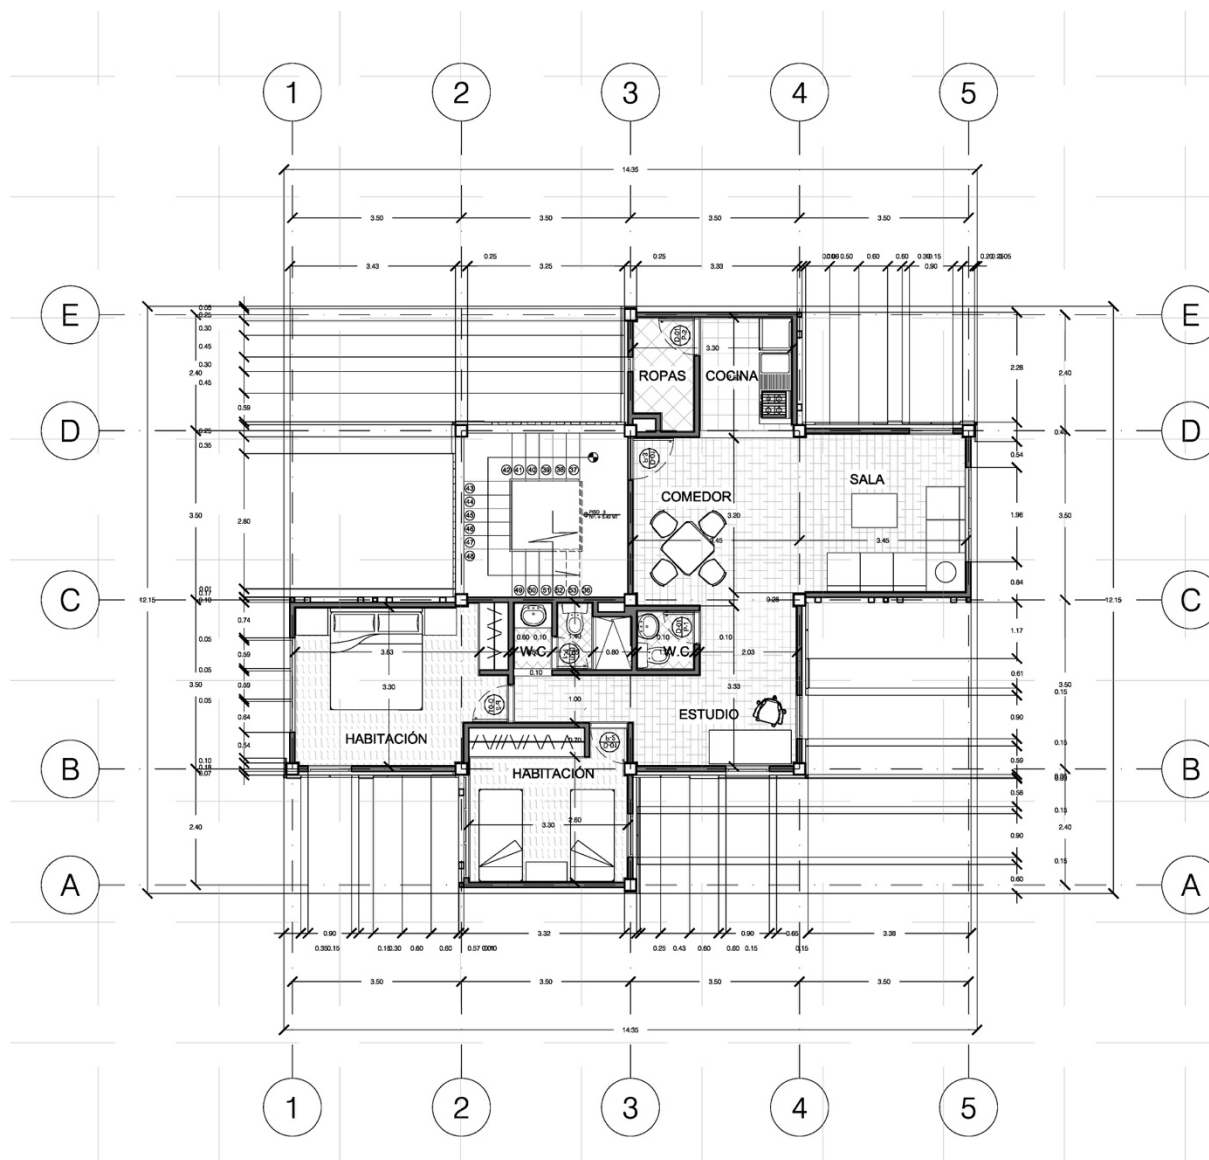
Planta arquitectónica tercer piso “Progresividad completa de la vivienda”
